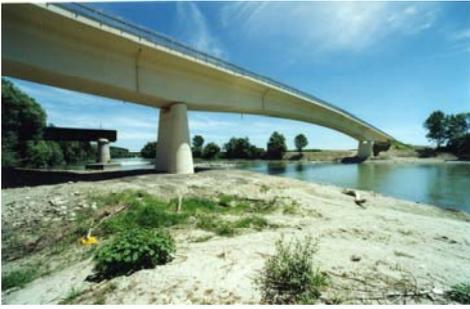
Nouveau pont de Felizzano avec l'image de l'ancienne structure au fond
